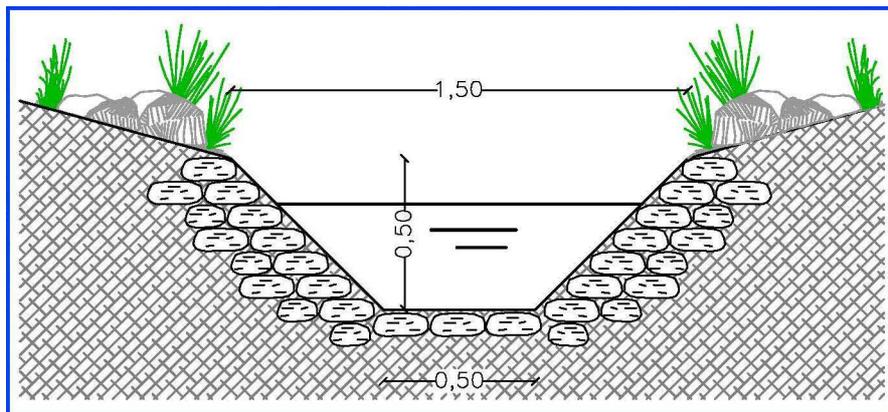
sezione trasversale del canale di guardia rivestito in pietra per canale Nord
